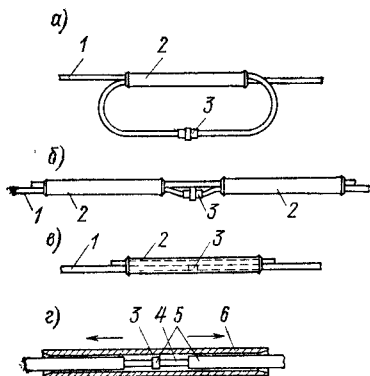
Сварные соединители проводов сечением до 185 мм^2 : а — в виде петли; б — с шунтом; в — со вставкой; г — соединитель проводов сечением 240 мм^2 и более (стрелками показано направление опрессования)
